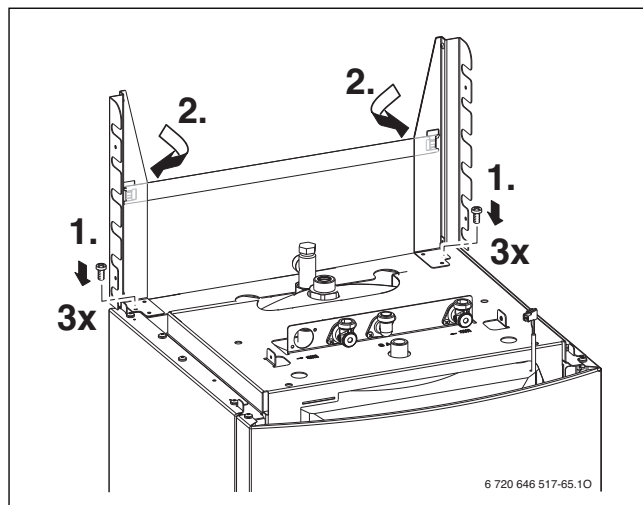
Přípojky na zásobníku u GB172-.. T210SR
